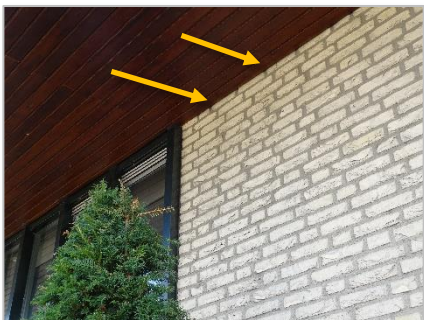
Pand 4 – kieren langs dakaansluiting gevel.
